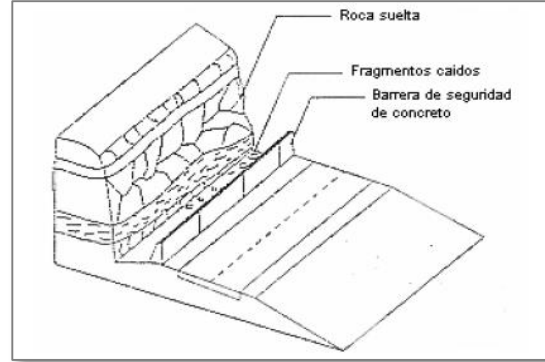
Muros de contención como barrera de protección (Suárez, 1998)
